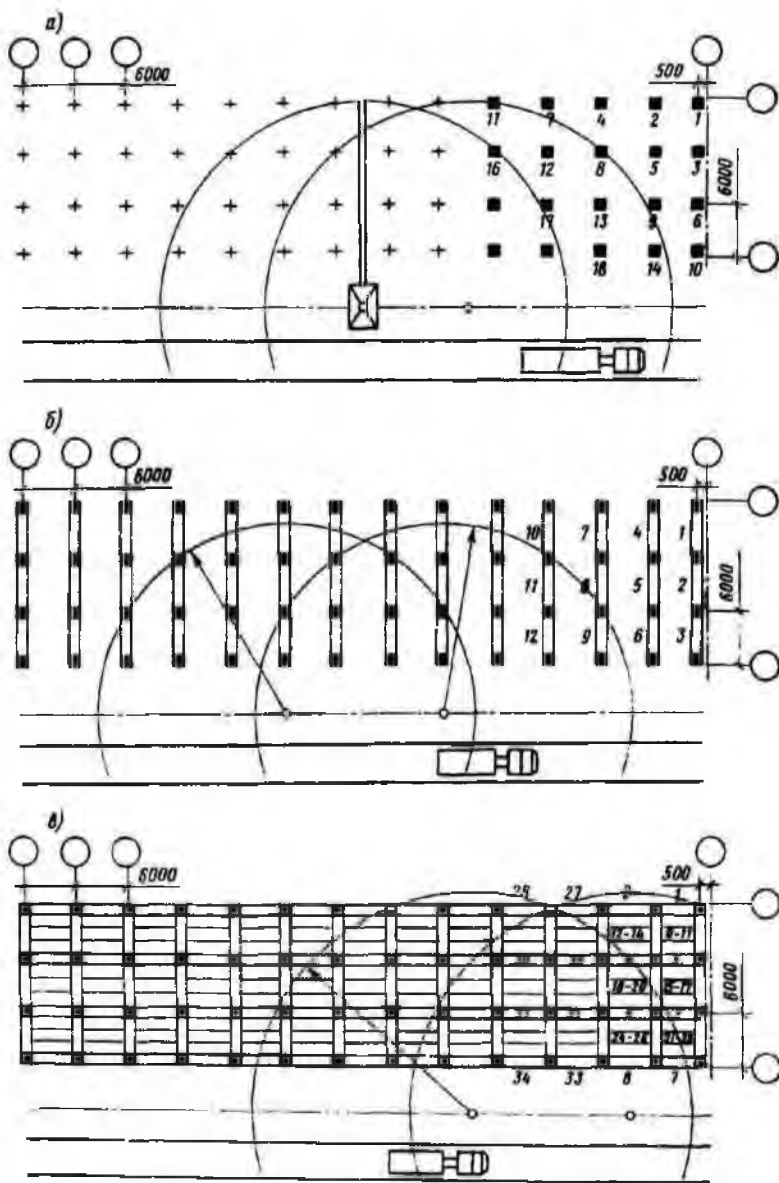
Схема монтажа бескрановых промышленных зданий башенным краном, установленным с одной стороны:
